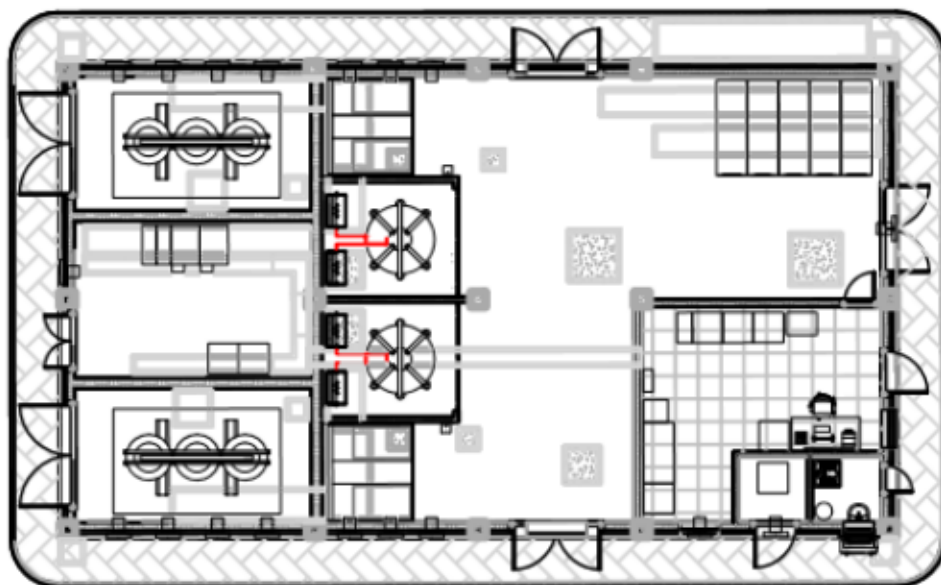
TIPOLOGICO: PIANTA FABBRICATO DI SSE
